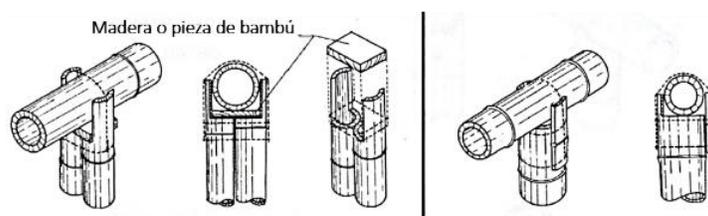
Soporte vertical con corte 2 orejas y pieza de madera
